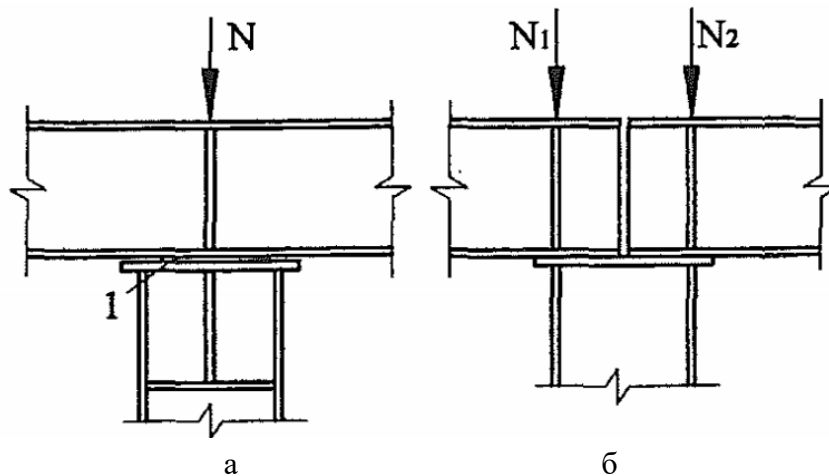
Варіанти передачі навантаження від балок: а – через підкладки; б – через внутрішні опорні ребра; 1– підкладка
